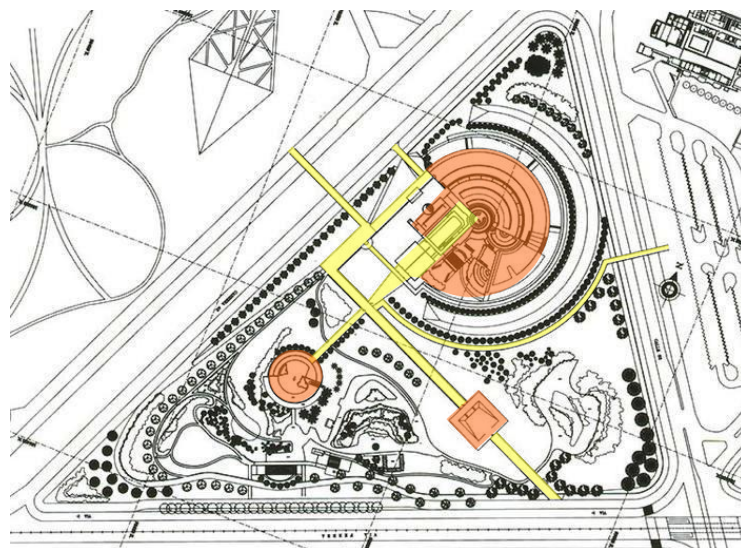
Planta general Biblioteca Virgilio Barco - archivo de la Biblioteca
